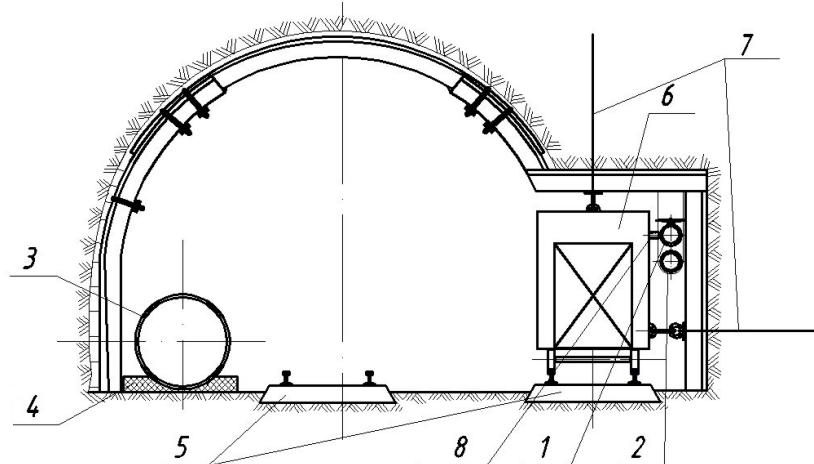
Размещение установки конструкции НГУ в нише горной выработки: 1- трубопровод сжатого воздуха; 2 – противопожарный трубопровод; 3 - дегазационный трубопровод; 4 – подложка (не металлическая) 5 - рельсовая дорога типа ДКНЛ-1; 6 – передвижная камера-убежище; 7 - анкера крепления камеры-убежища; 8 - подвод сжатого воздуха к камере.
